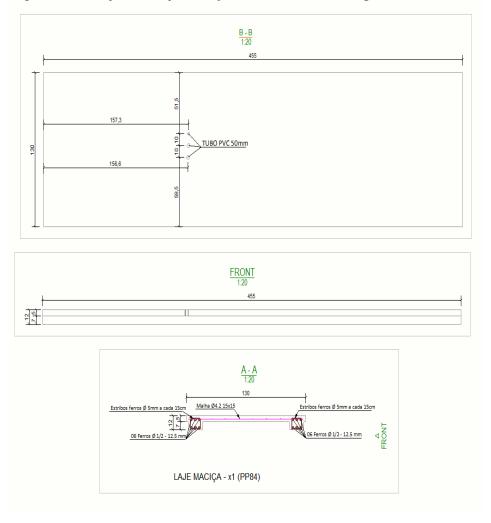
Projeto de laje maciça de concreto armado pré-moldado.
